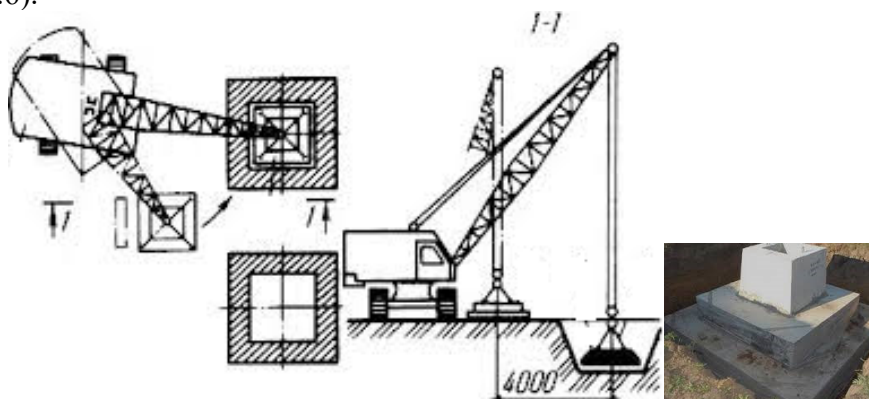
Схема монтажу фундаментних блоків стаканного типу
